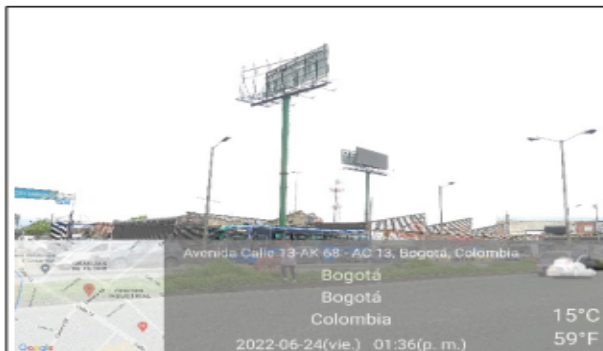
Vista panorámica del sitio de traslado de la valla en la Av. Carrera 68 No. 13 - 24 (dirección catastral) Orientación Norte-Sur
